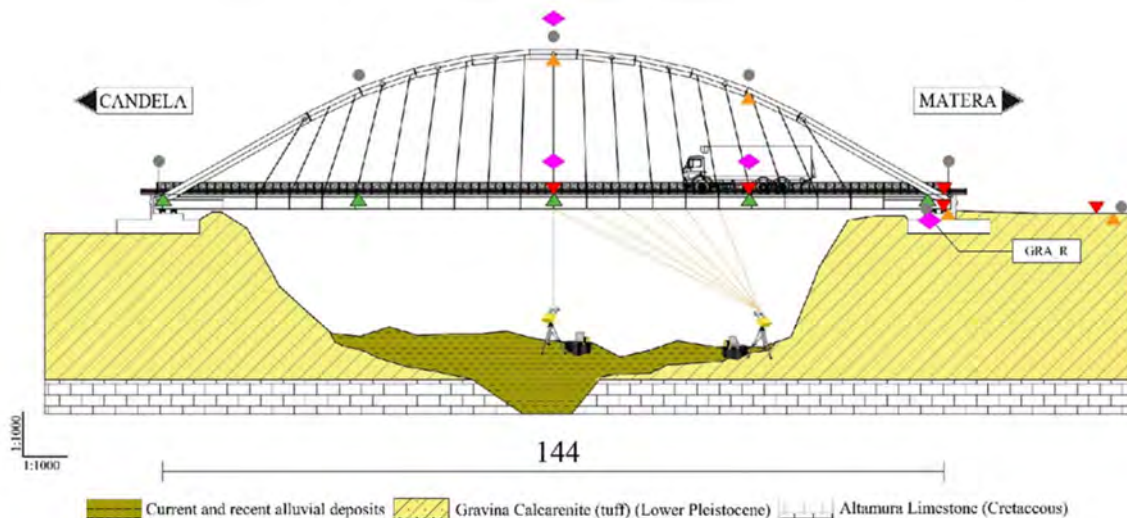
Applicazione TInRAR su strutture a sviluppo orizzontale (Serlenga et al., 2021)
